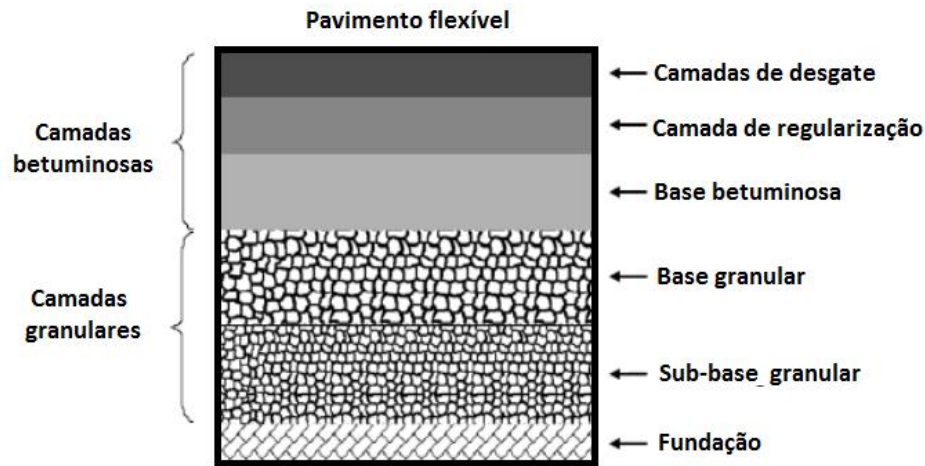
Constituição tipo de pavimento flexível (adaptado de Lopes 2009)
